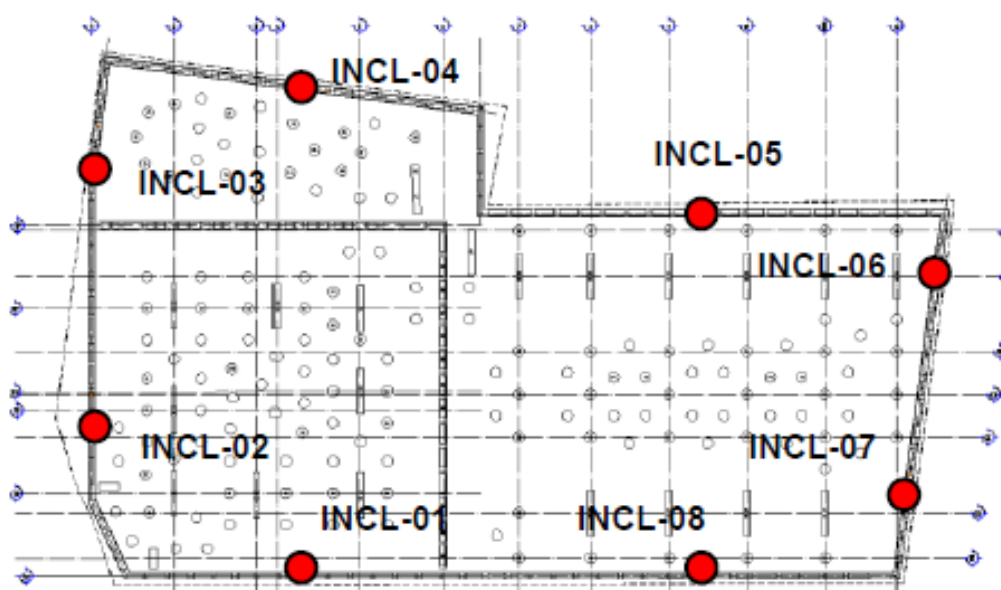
Ubicación de los inclinómetros dentro del área de construcción.
